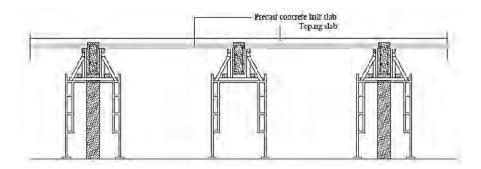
Pemasangan Pelat *Precast Half Slab* Sumber : Ervianto, Eksplorasi Teknologi Dalam Proyek Konstruksi Beton Pracetak & Bekisting , 2006
